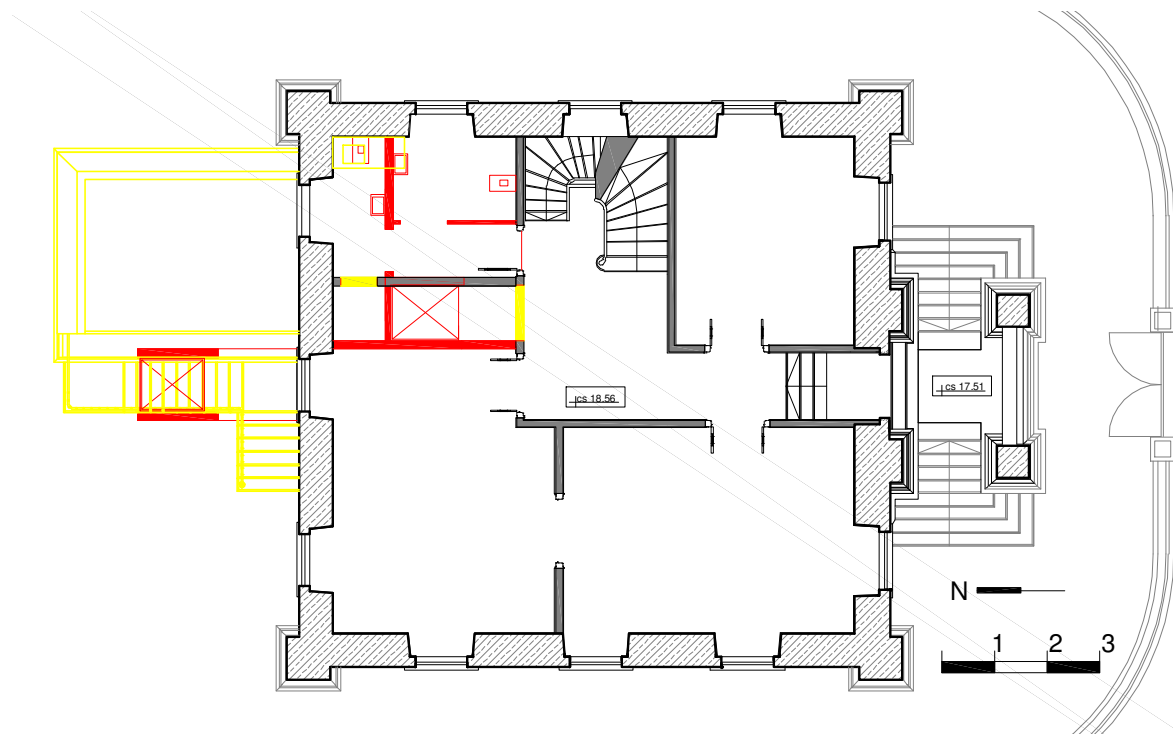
Planta do Piso 1 com as Cores Convencionais
